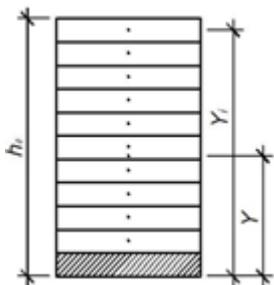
Расчетное сечение изгибаемого железобетонного элемента
